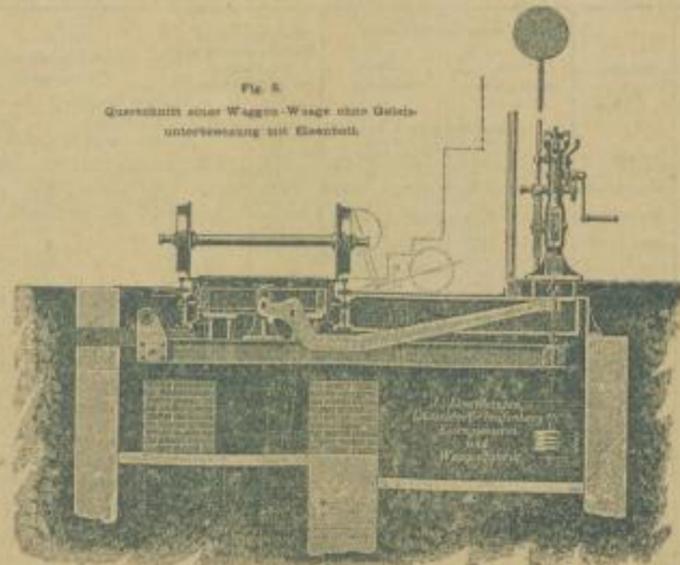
Querschnitt einer Waagen-Waage ohne Geleisunterbrechung mit Eisenbett.
